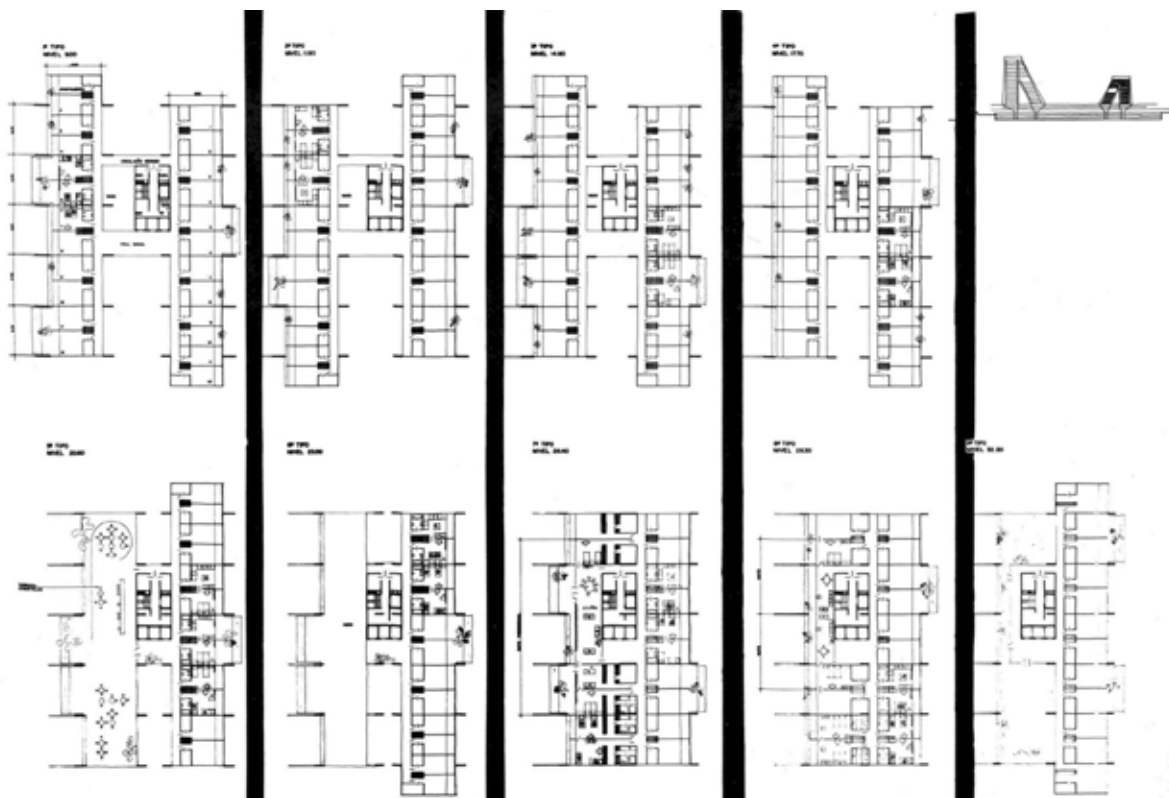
Euro Kursaal; Projeto B; plantas dos diversos pavimentos do Bloco destinado ao Hotel.
